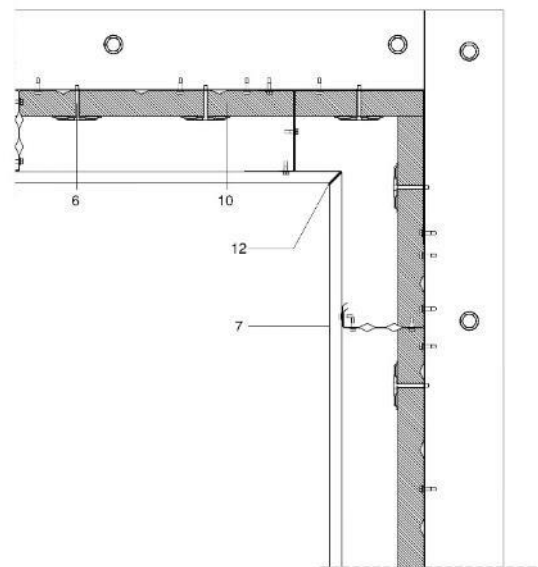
b: Detalle de esquina entrante (rincón) con aislamiento térmico.
